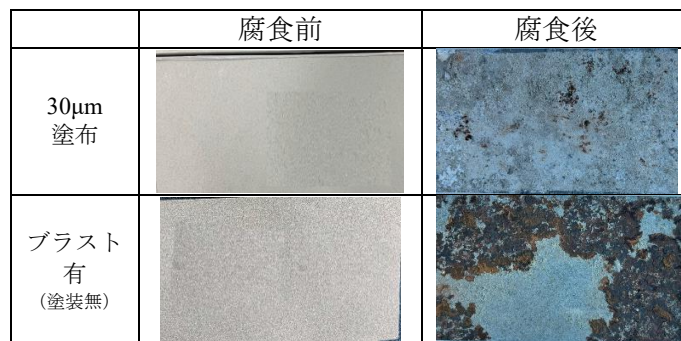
腐食前後の鉄板の様子 (かぶり 20mm)
